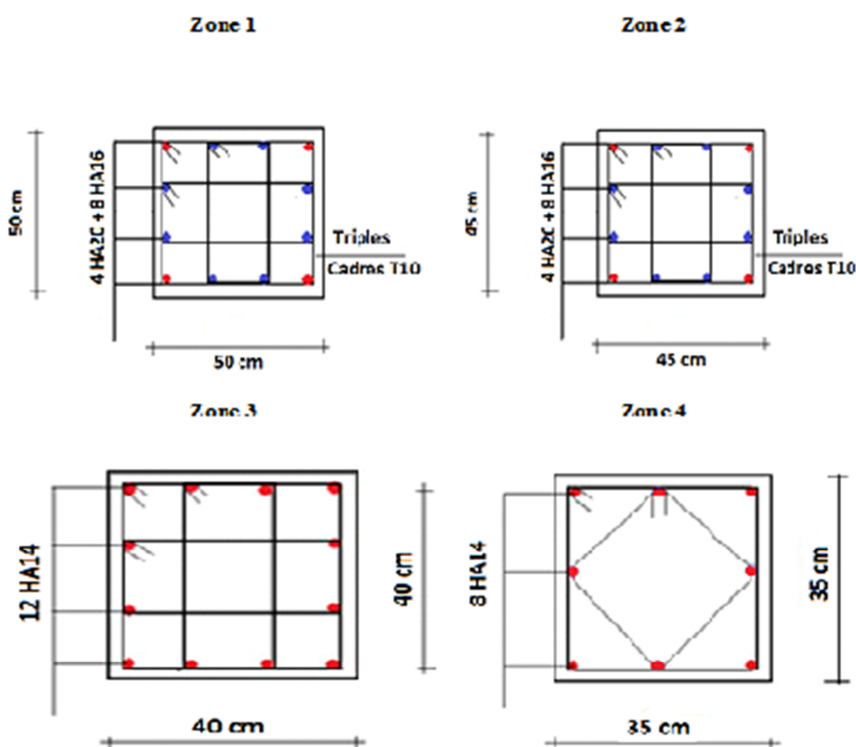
Schémas de ferrailage des sections des poteaux.
